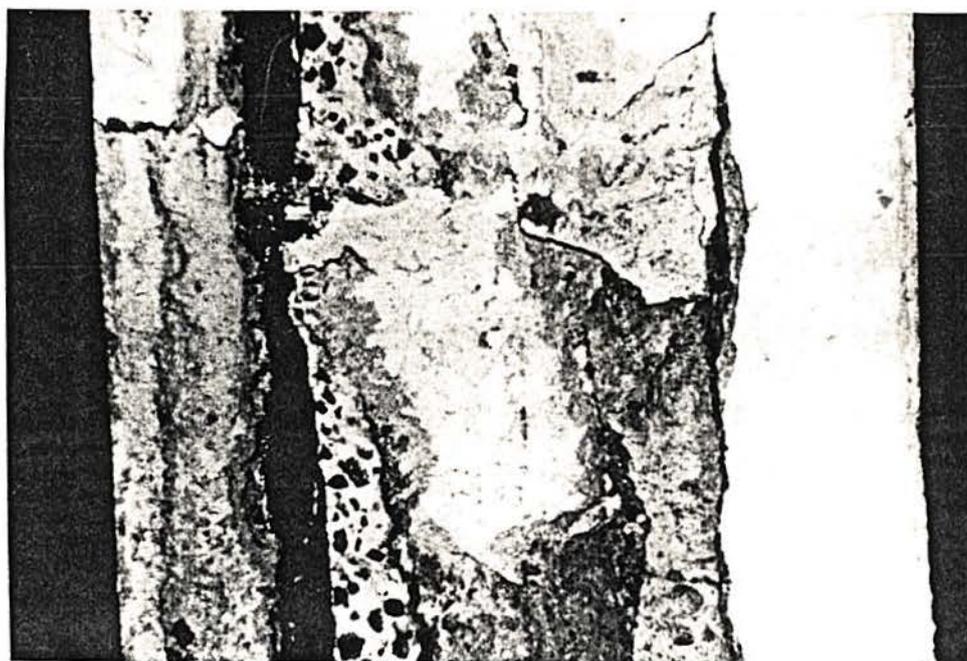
Aspecto da armadura longitudinal de um pilar na presença de corrosão de armadura generalizada e perda da seção de concreto por lascamento
